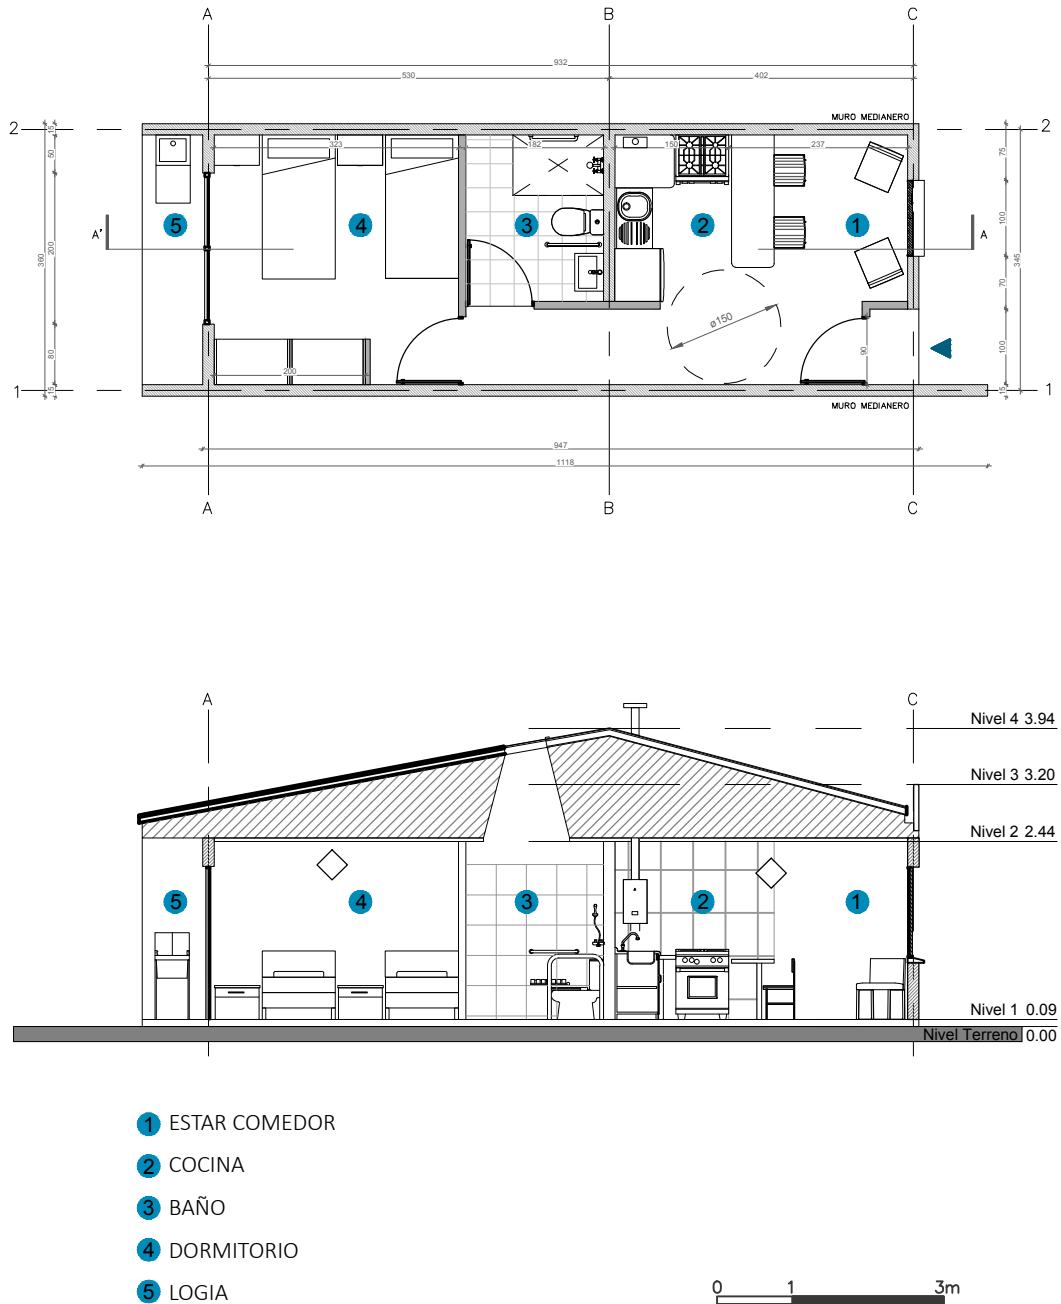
Planta y corte de una vivienda tipo CVT Marchigüe.
